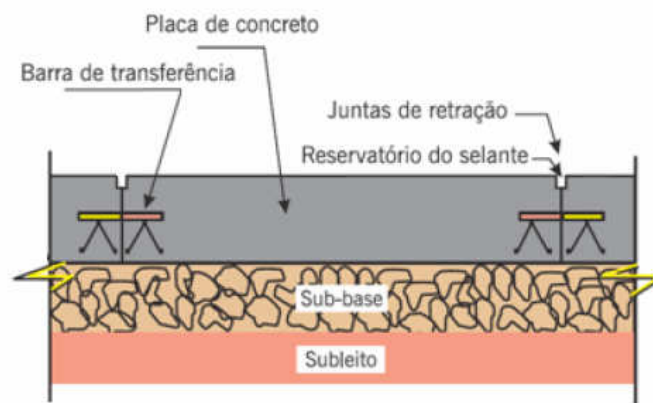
Pavimento rígido (Bianchi, Brito, Castro)
